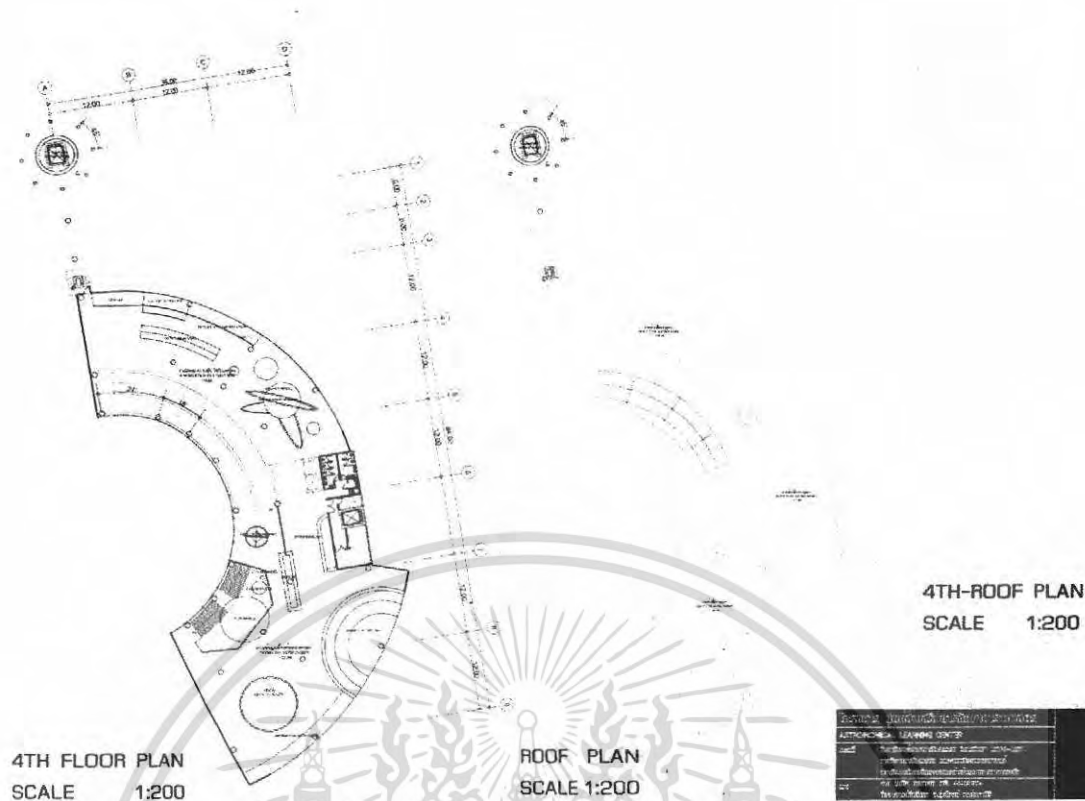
แสดงผังพื้นที่ 2
